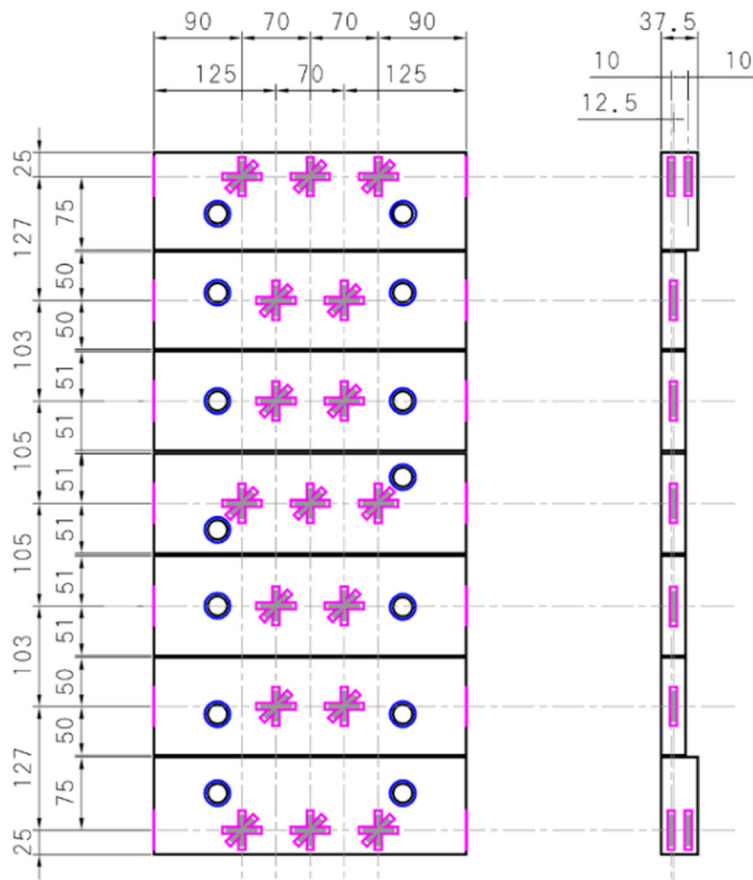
ひずみゲージ位置図（鉄筋）
